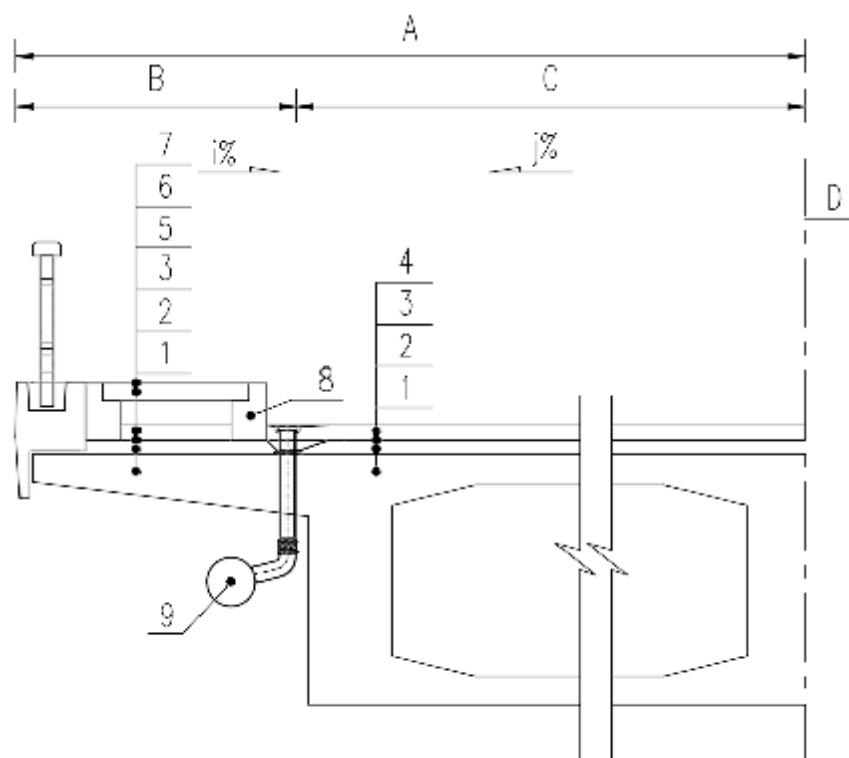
增设混凝土人行道盖板承载行人行走的混凝土桥面板结构
